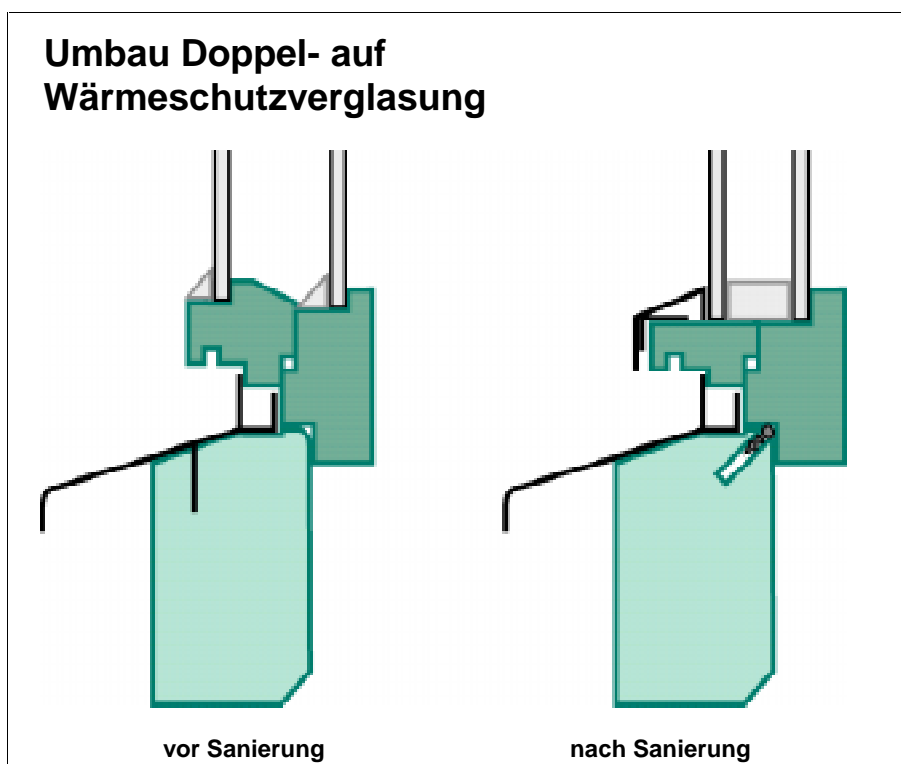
Sanierung eines doppelverglasteten Fensters durch Umbau auf Wärmeschutzverglasung. Bei den Abstandhaltern ist darauf zu achten, dass sie aus schlecht wärmeleitendem Material bestehen (z.B. Chromstahl).
